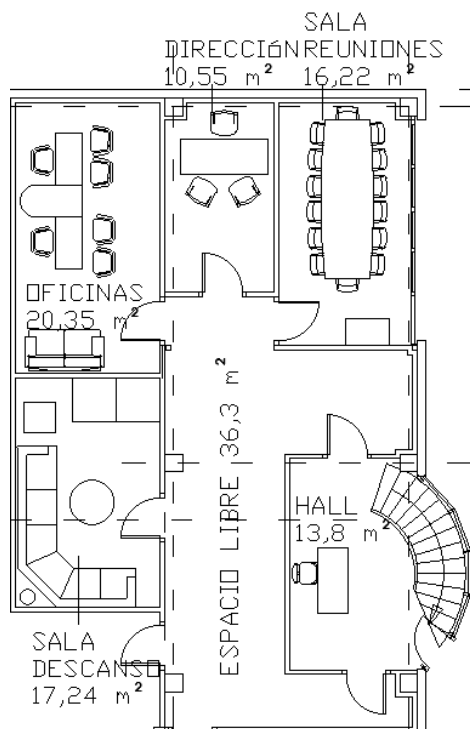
Zona de oficinas. Fuente: Proyectista
